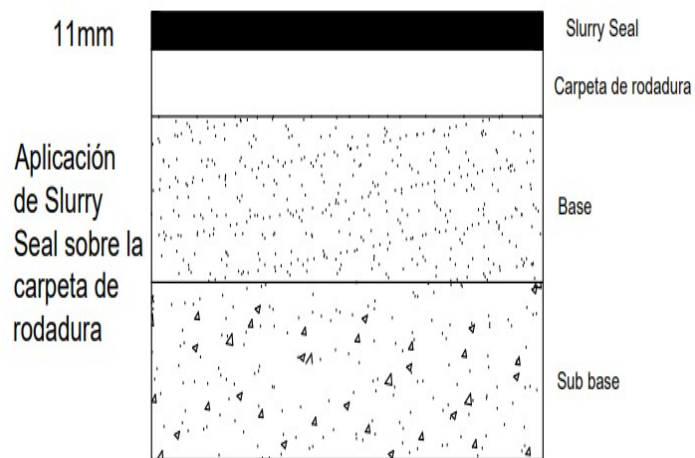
Pavimento flexible con Slurry Seal como tratamiento de superficie
